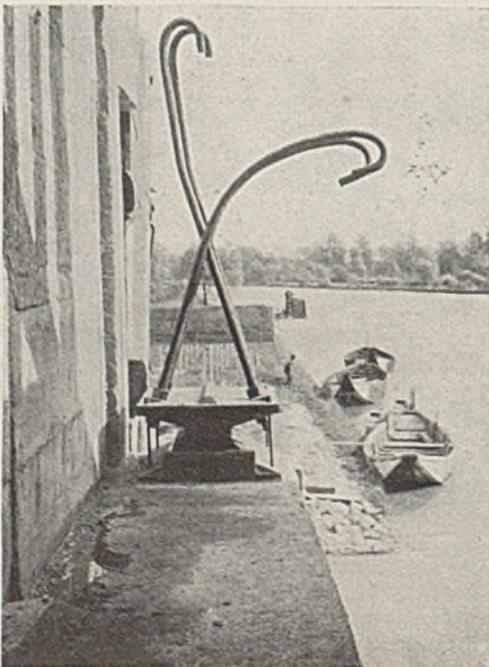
Stahlguß-Gleitlager des eingehängten Trägers auf der Konsole versetzt.
